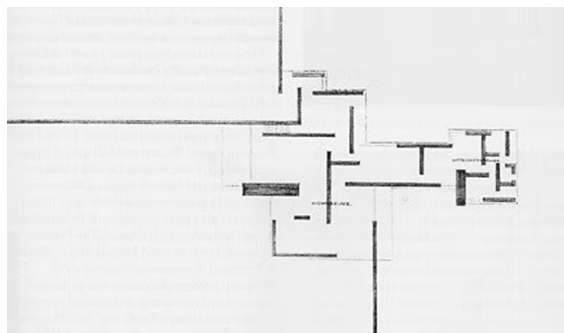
Planta da Casa de Campo de Tijolo, por Mies van der Rohe
